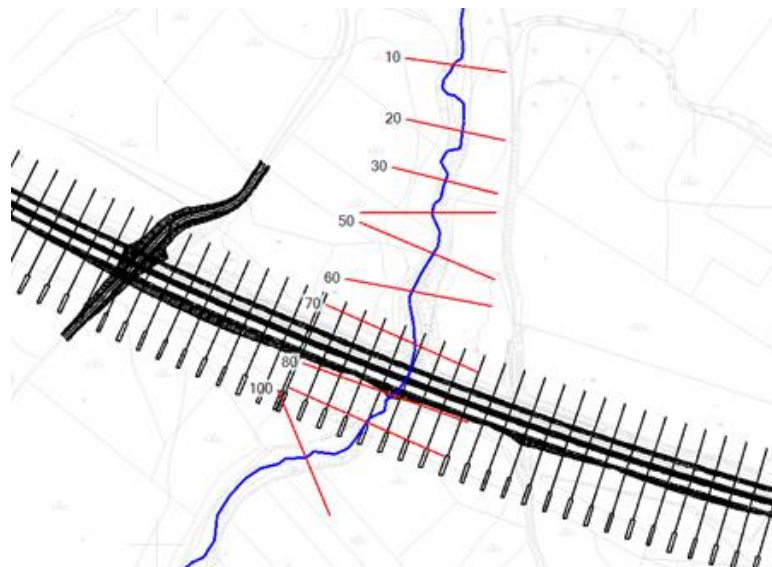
Inquadramento planimetrico della nuova opera VI23: sezioni modellate (planimetria modello idraulico)
